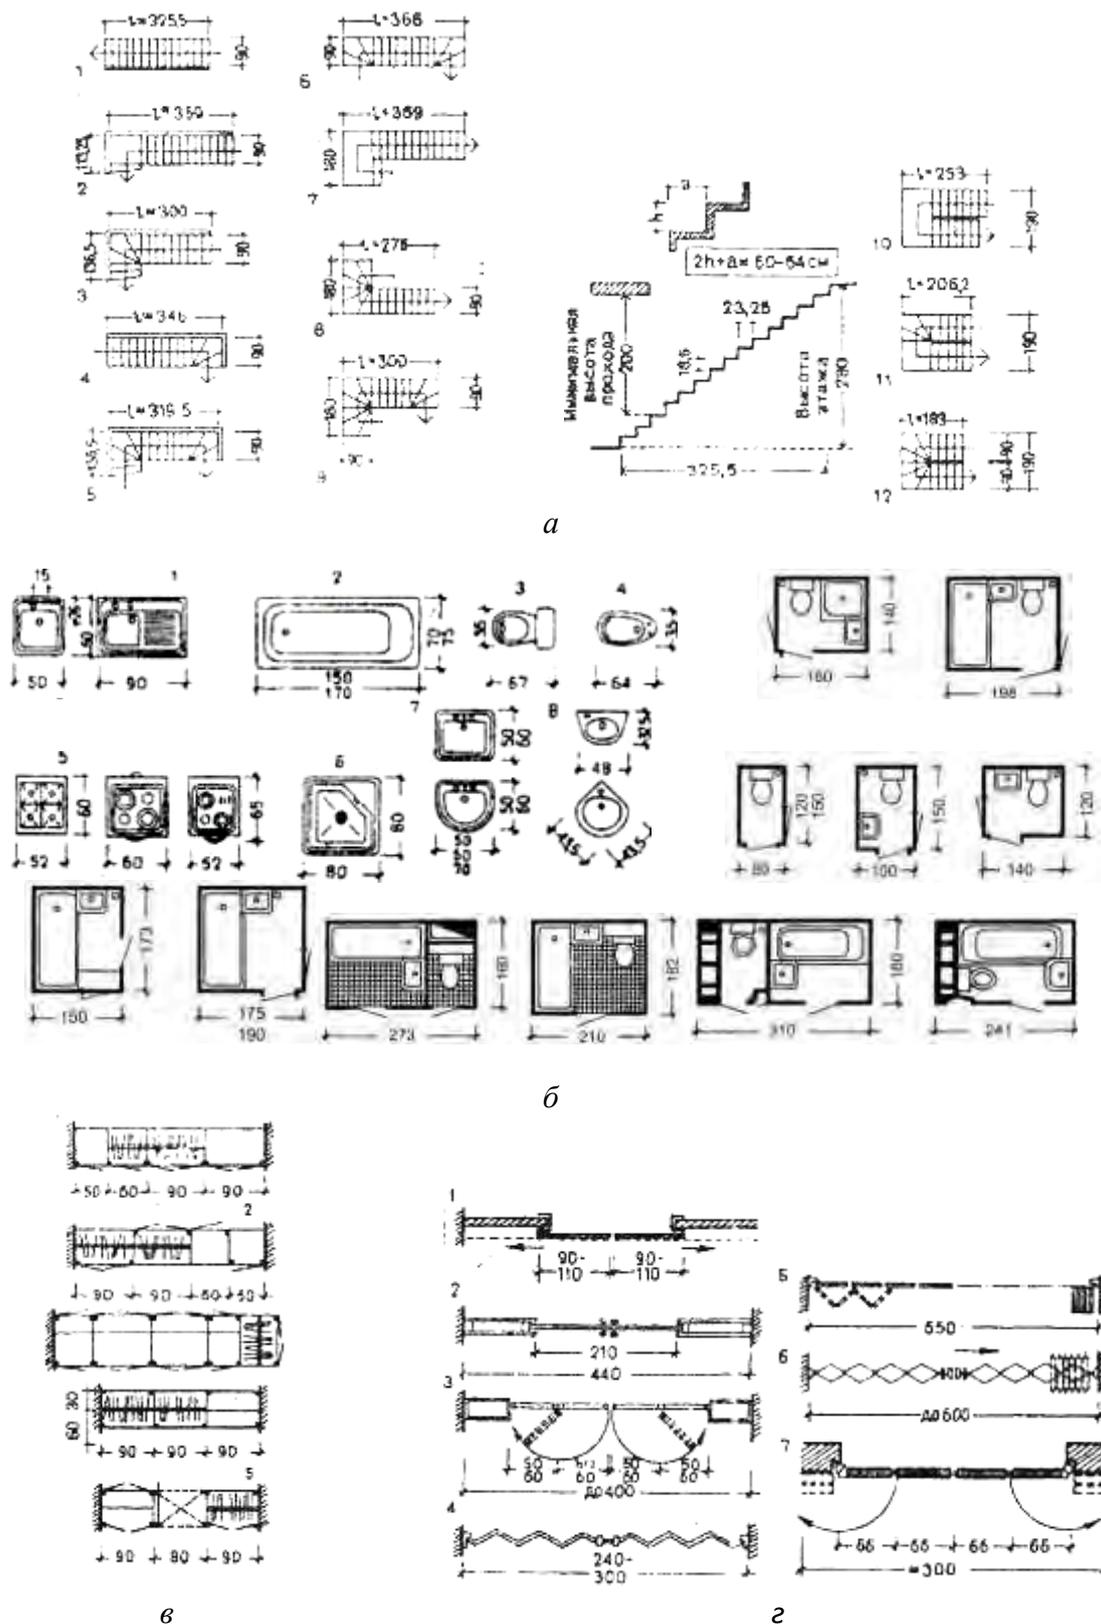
Элементы оборудования квартир: а — внутриквартирные лестницы; б — оборудование сантехнических помещений; в — типы встроенных шкафов и шкафных перегородок; г — трансформирующиеся двери и перегородки
